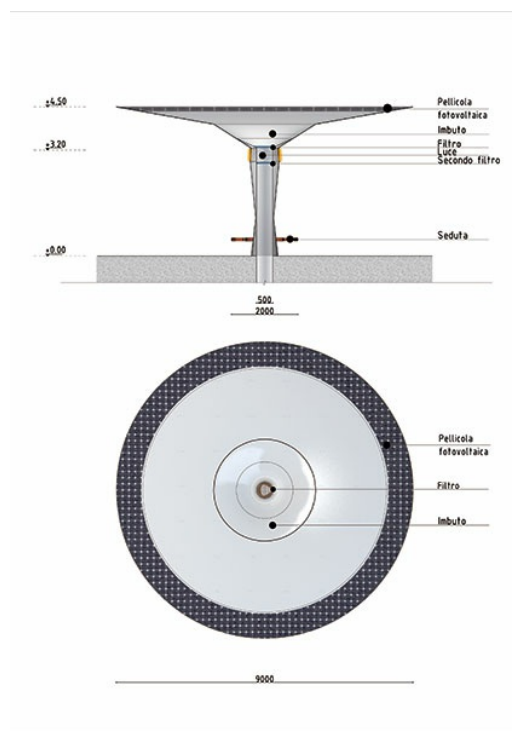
Schema di progetto (*alzato e vista dall'alto*) dell'elemento ispirato alla bromelia (design: Studio Lauria).
